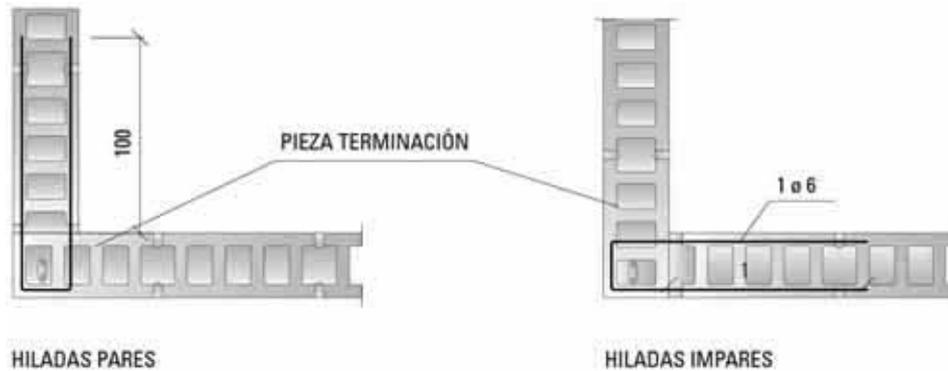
Refuerzo vertical y macizado en esquinas de muros de bloque hueco.
